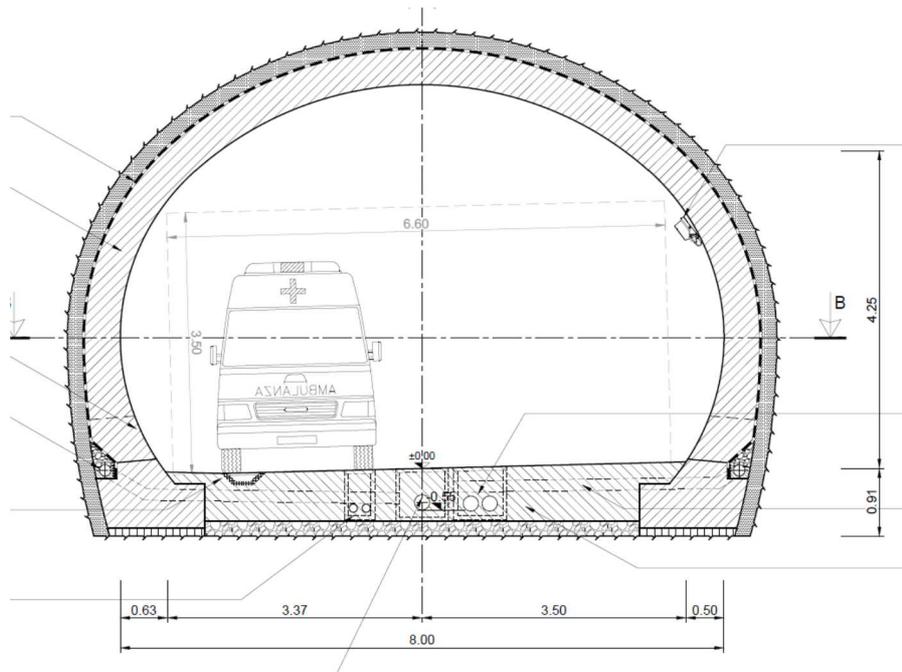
sezione corrente a doppio senso - galleria di connessione 1
